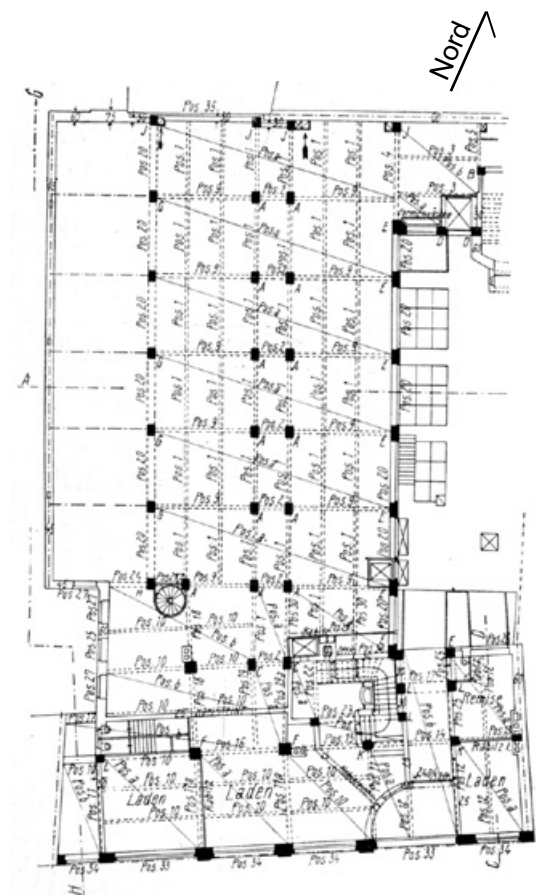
Grundriss erster Bauabschnitt (Emperger 1915, S. 598, Abb. 166).
